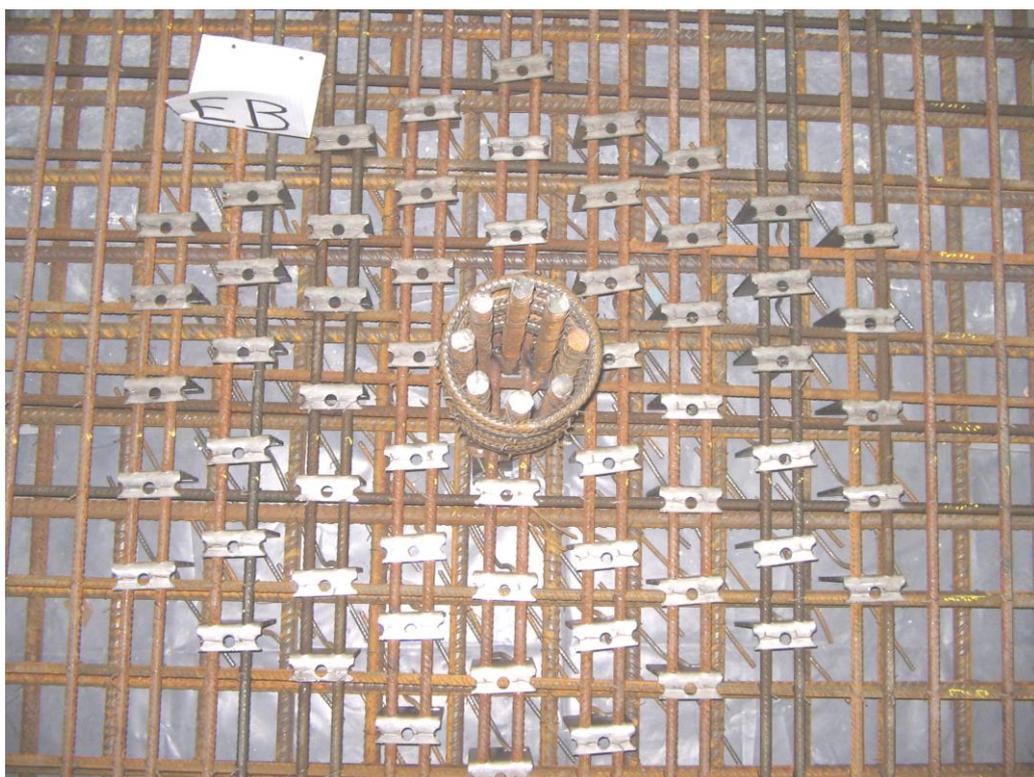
Untere Bewehrung mit Lage der Einbauteile – Versuchskörper EB
